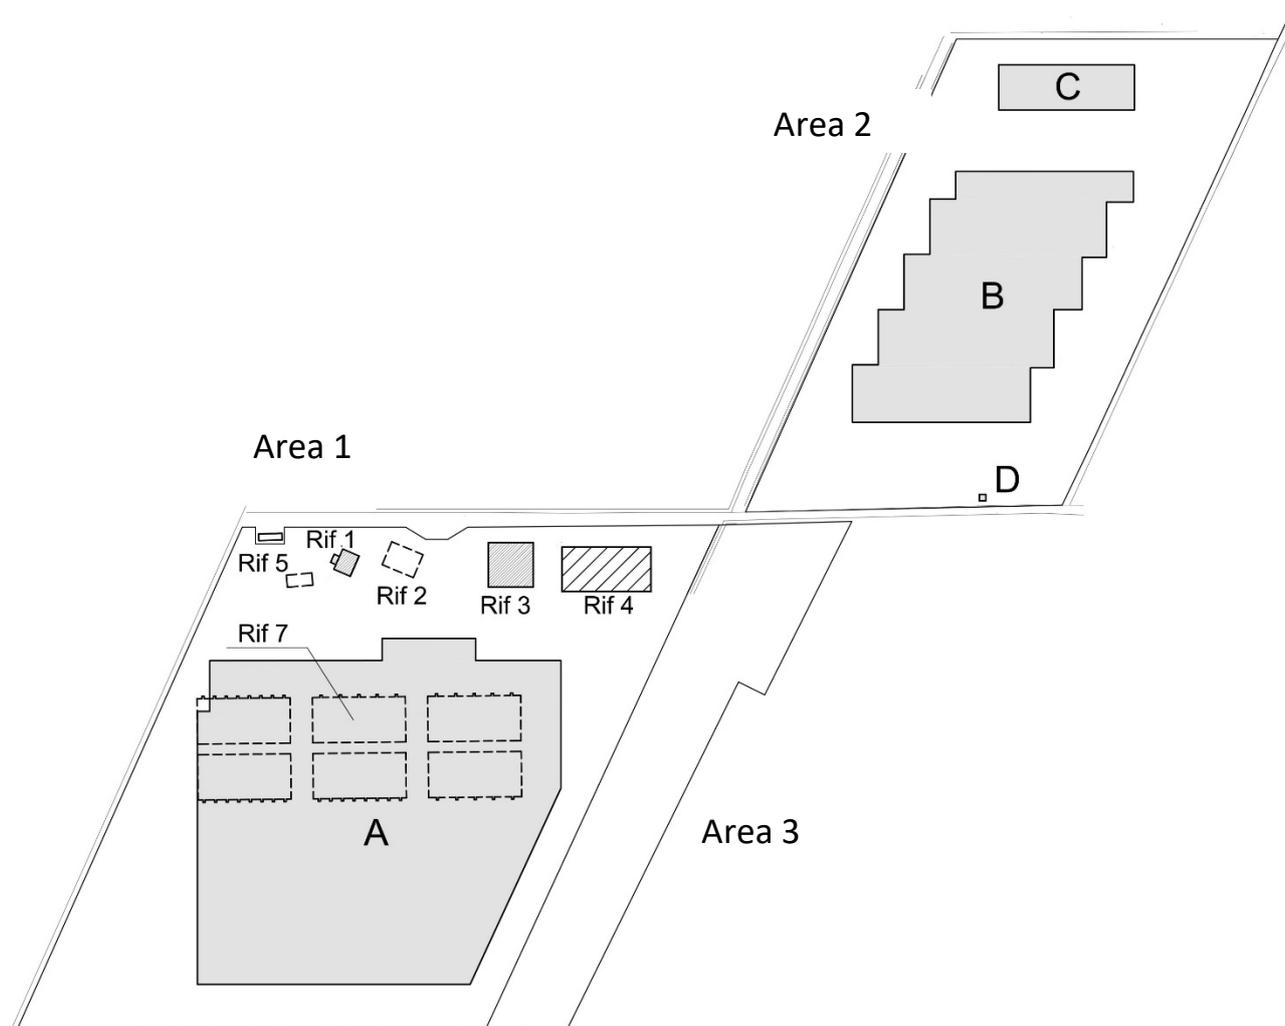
Area 1 e 2 - Pianta chiave dello stato di progetto per la nuova edificazione
